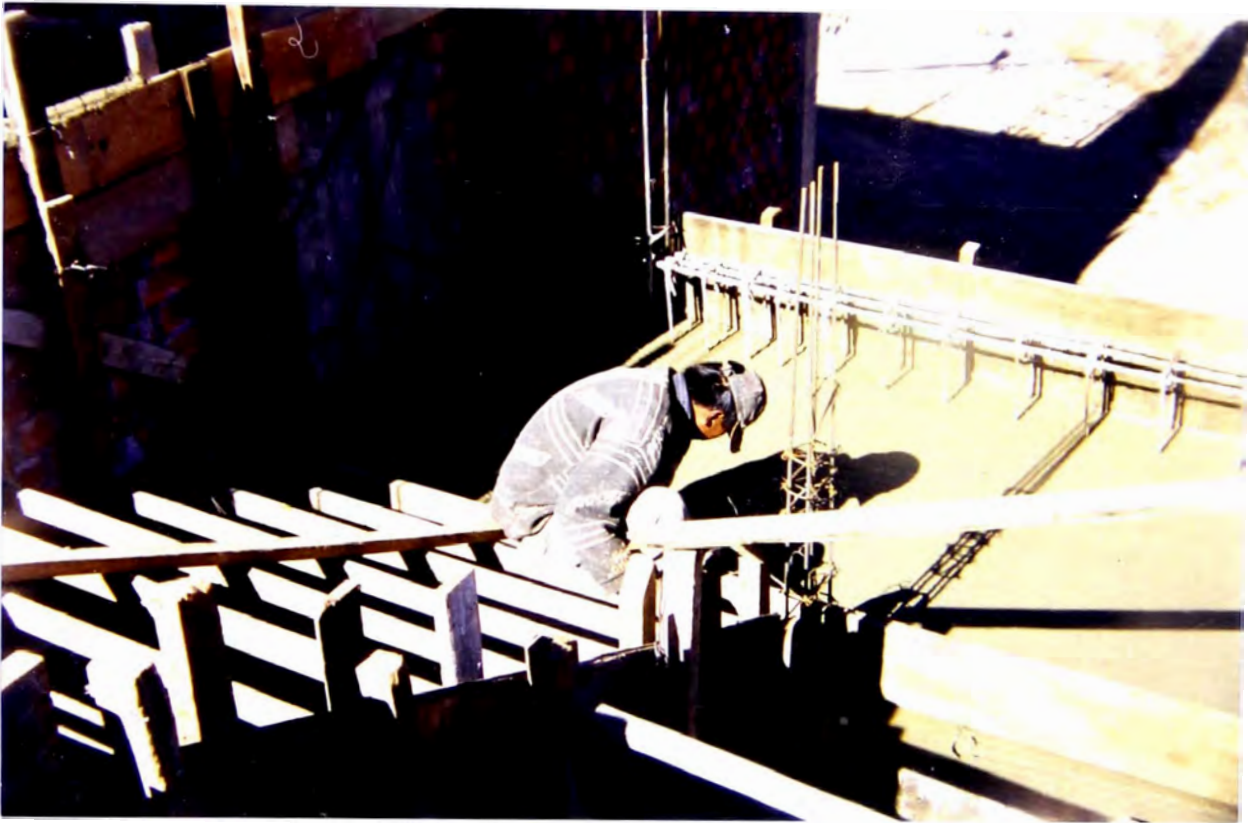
Aquí se ve que se a terminado de vaciar con concreto la losa maciza del primer descanso de la escalera.
